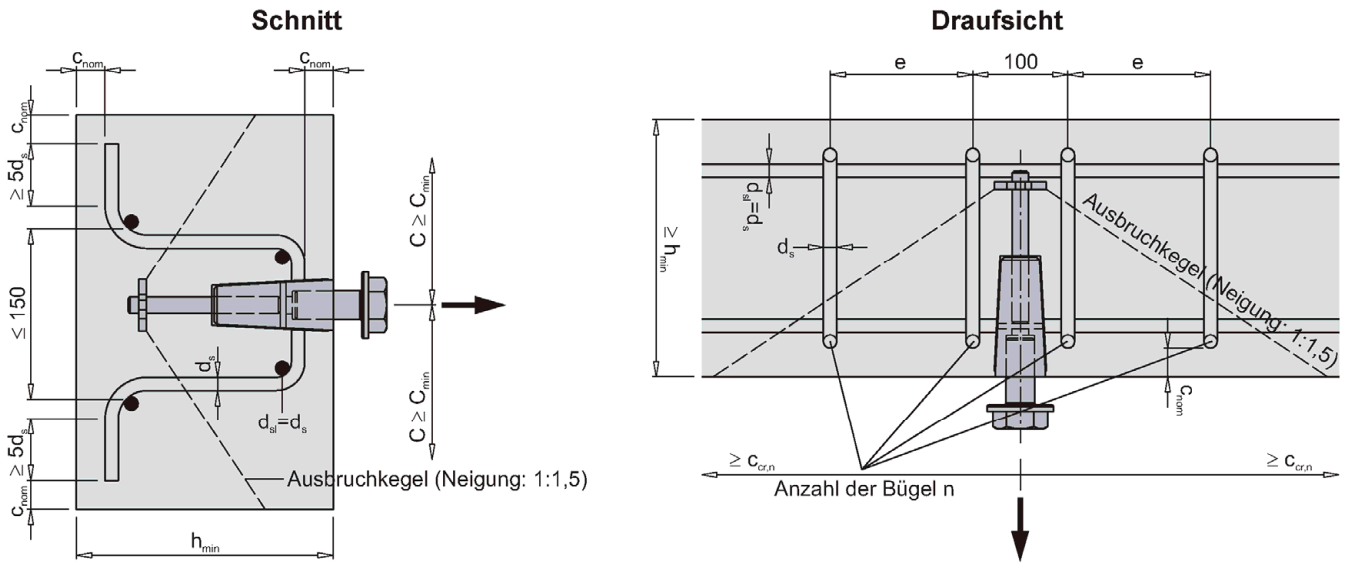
Einbausituation in dünne Wände - Zugbeanspruchung mit Rückhängebewehrung - Bewehrungslage
